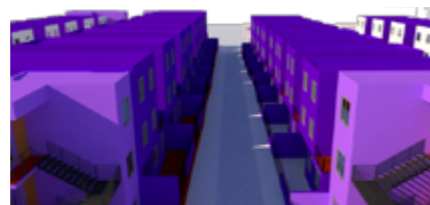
/4 pisos fachada continua en calles de mayores dimensiones
